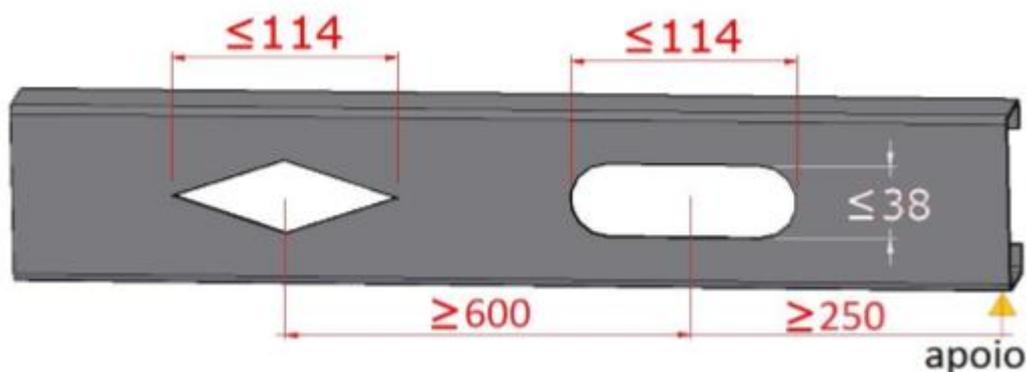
Exemplo de perfurações em perfis metálicos
